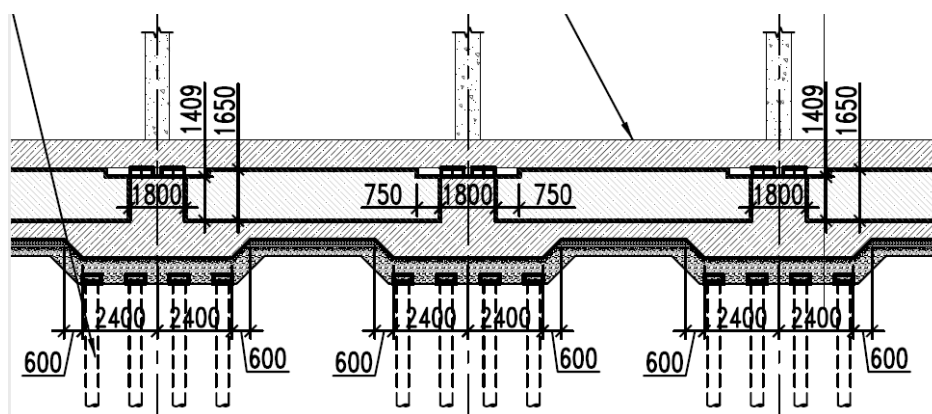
Вид монолитного фундамента со свайным основанием
